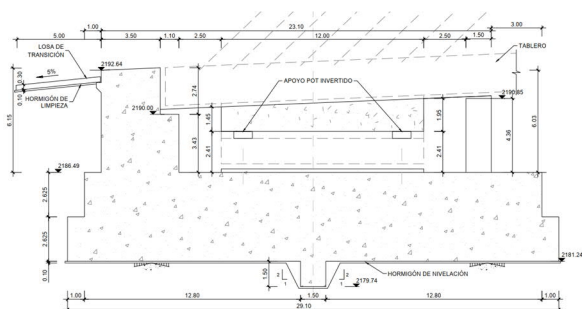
Sección longitudinal de un estribo. Fuente: TYPESA.
